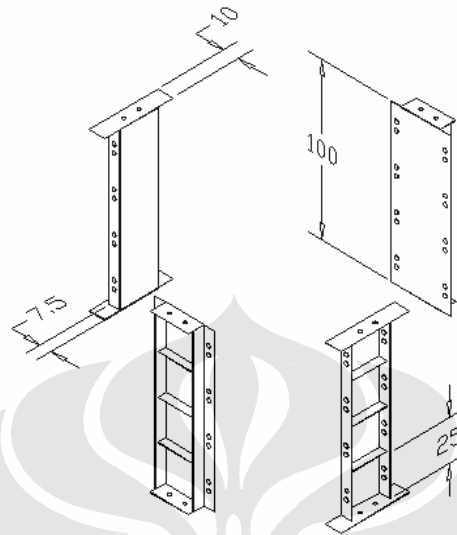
Bekisting baja elemen pedestal pondasi
